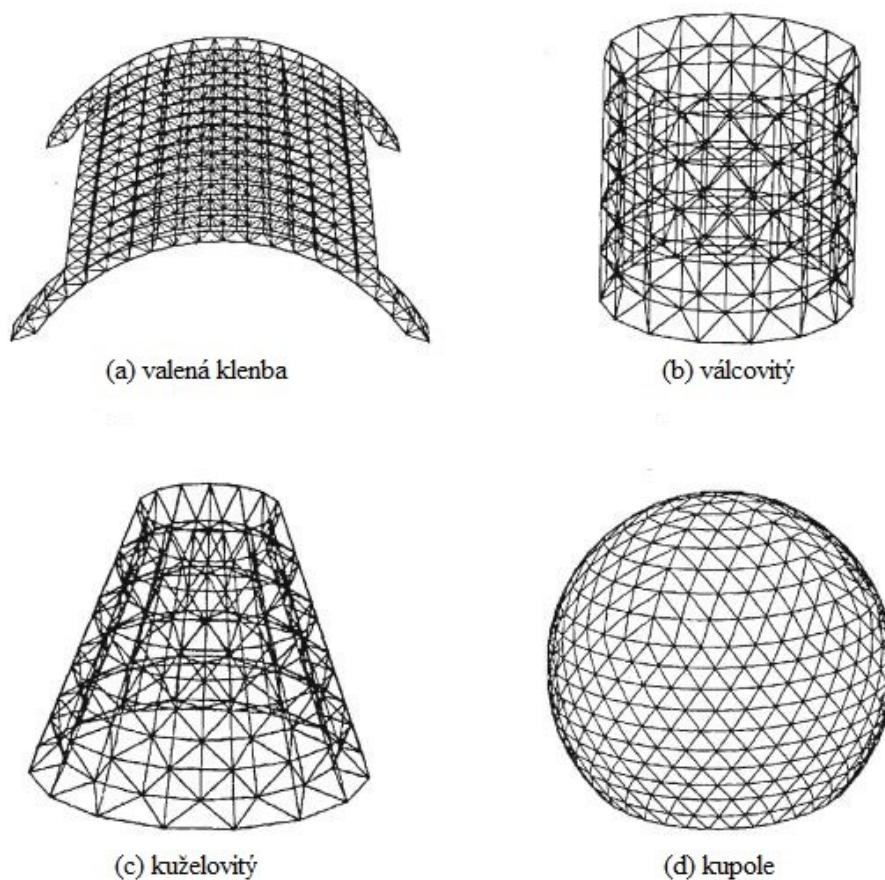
Nejčastěji používané typy skládaných deskových konstrukcí
